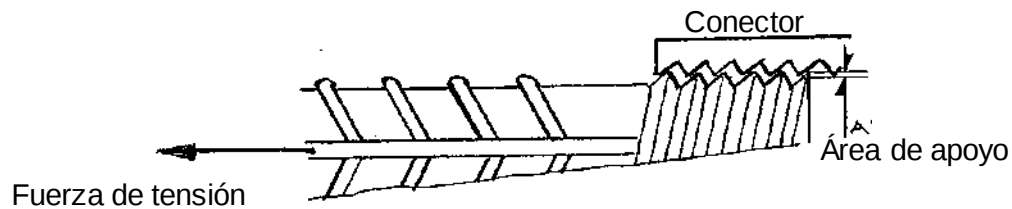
Ensamble de varilla roscada-conector que provoca barrido de cuerdas.
